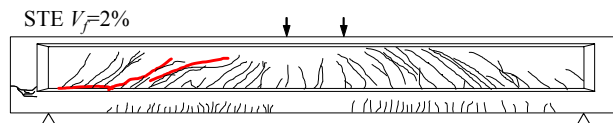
STEを用いたUFGはりのひび割れ状況
